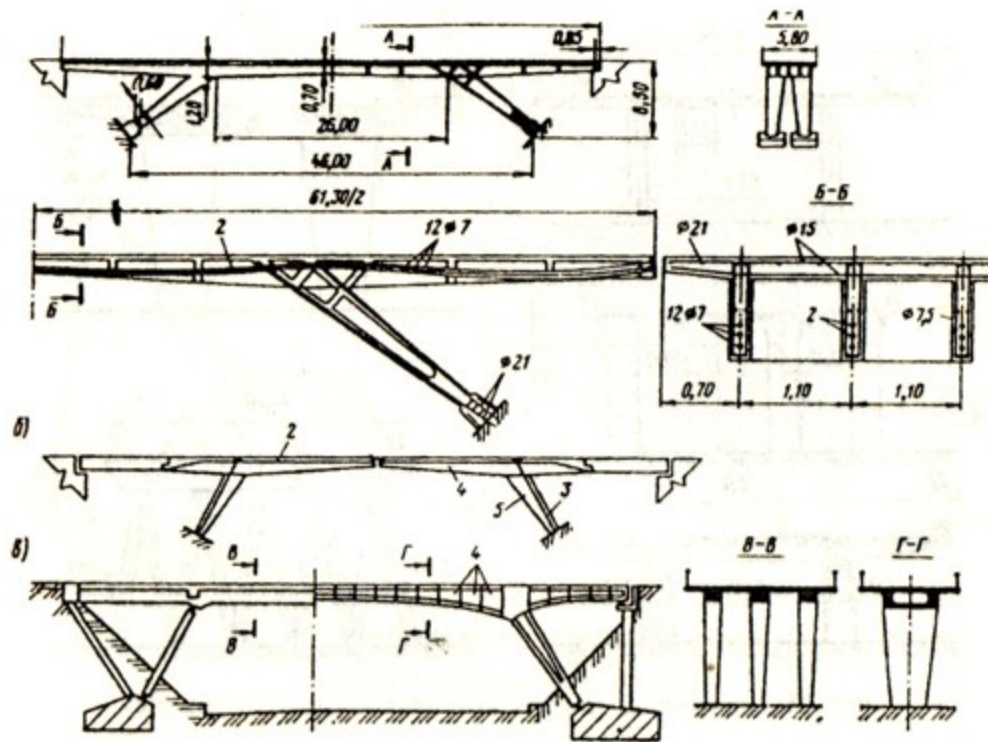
Конструкция железобетонных путепроводов рамной и комбинированной систем:
